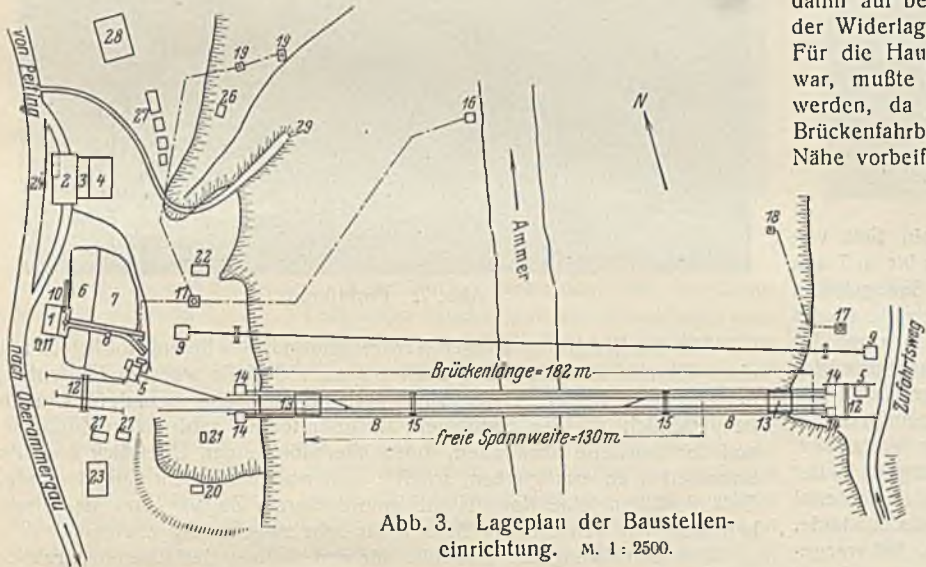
Lageplan der Baustelleneinrichtung. M. 1: 2500.
